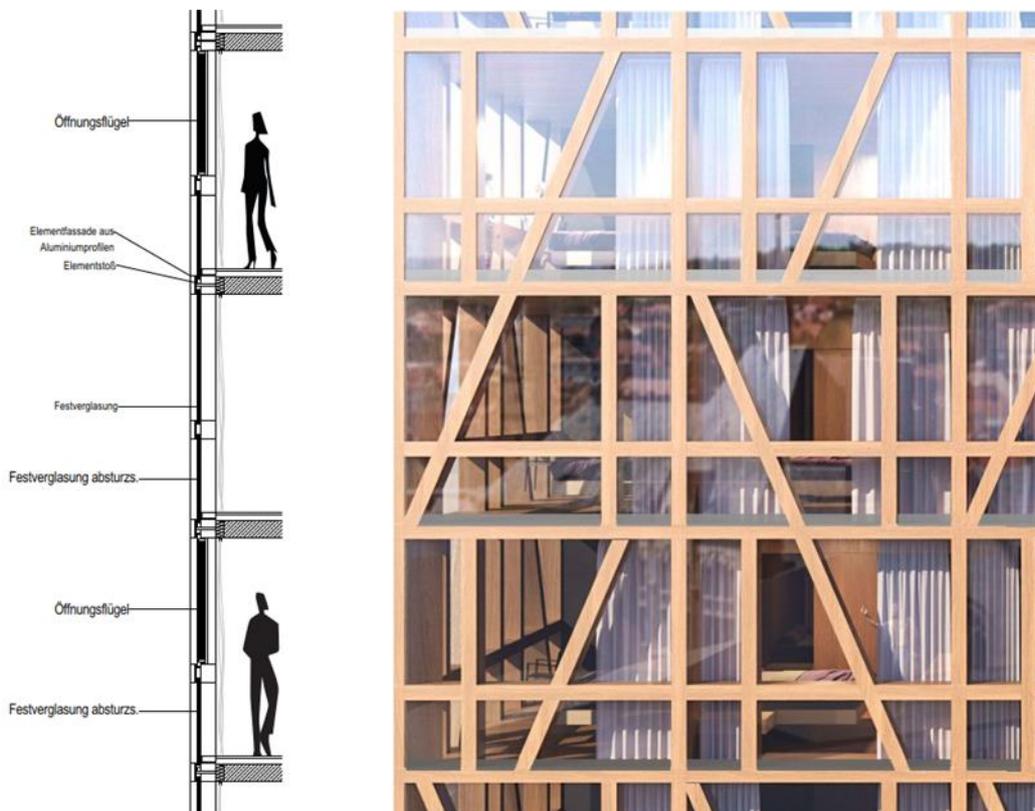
Leitdetail Fassadenansicht/-schnitt
